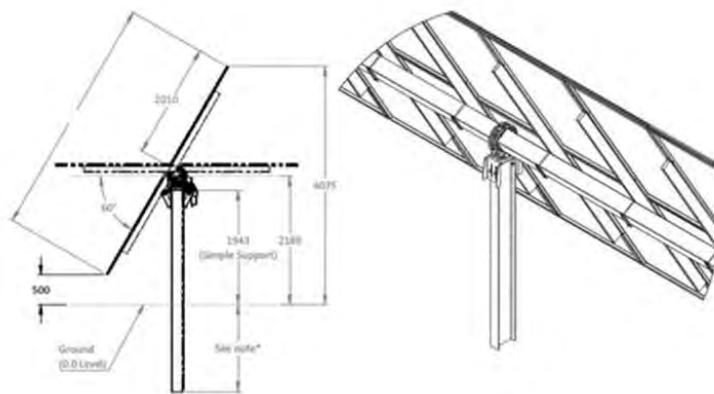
Perfiles de cimentación estructura seguidor Perfil seguidor solar y detalle del eje.
